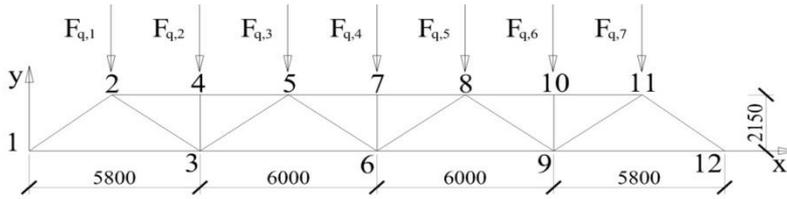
Розрахункова схема для визначення зусиль в стержнях ферми від дії постійного навантаження.
